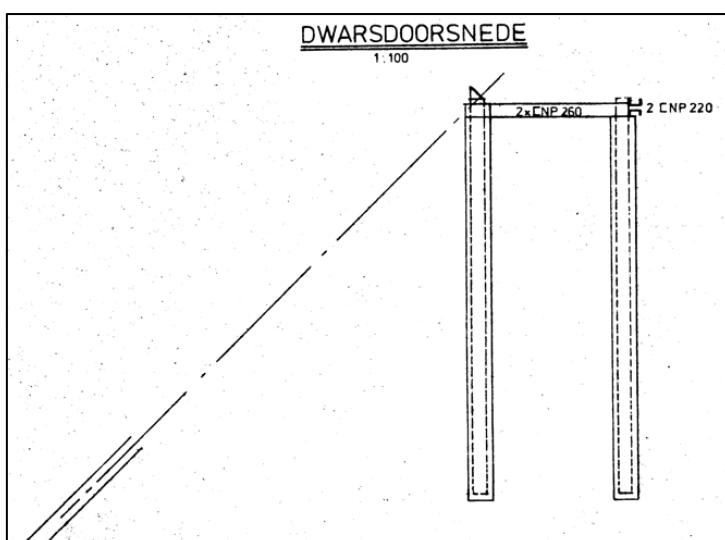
Bestaande constructie sectie 266-6/7 [49]
